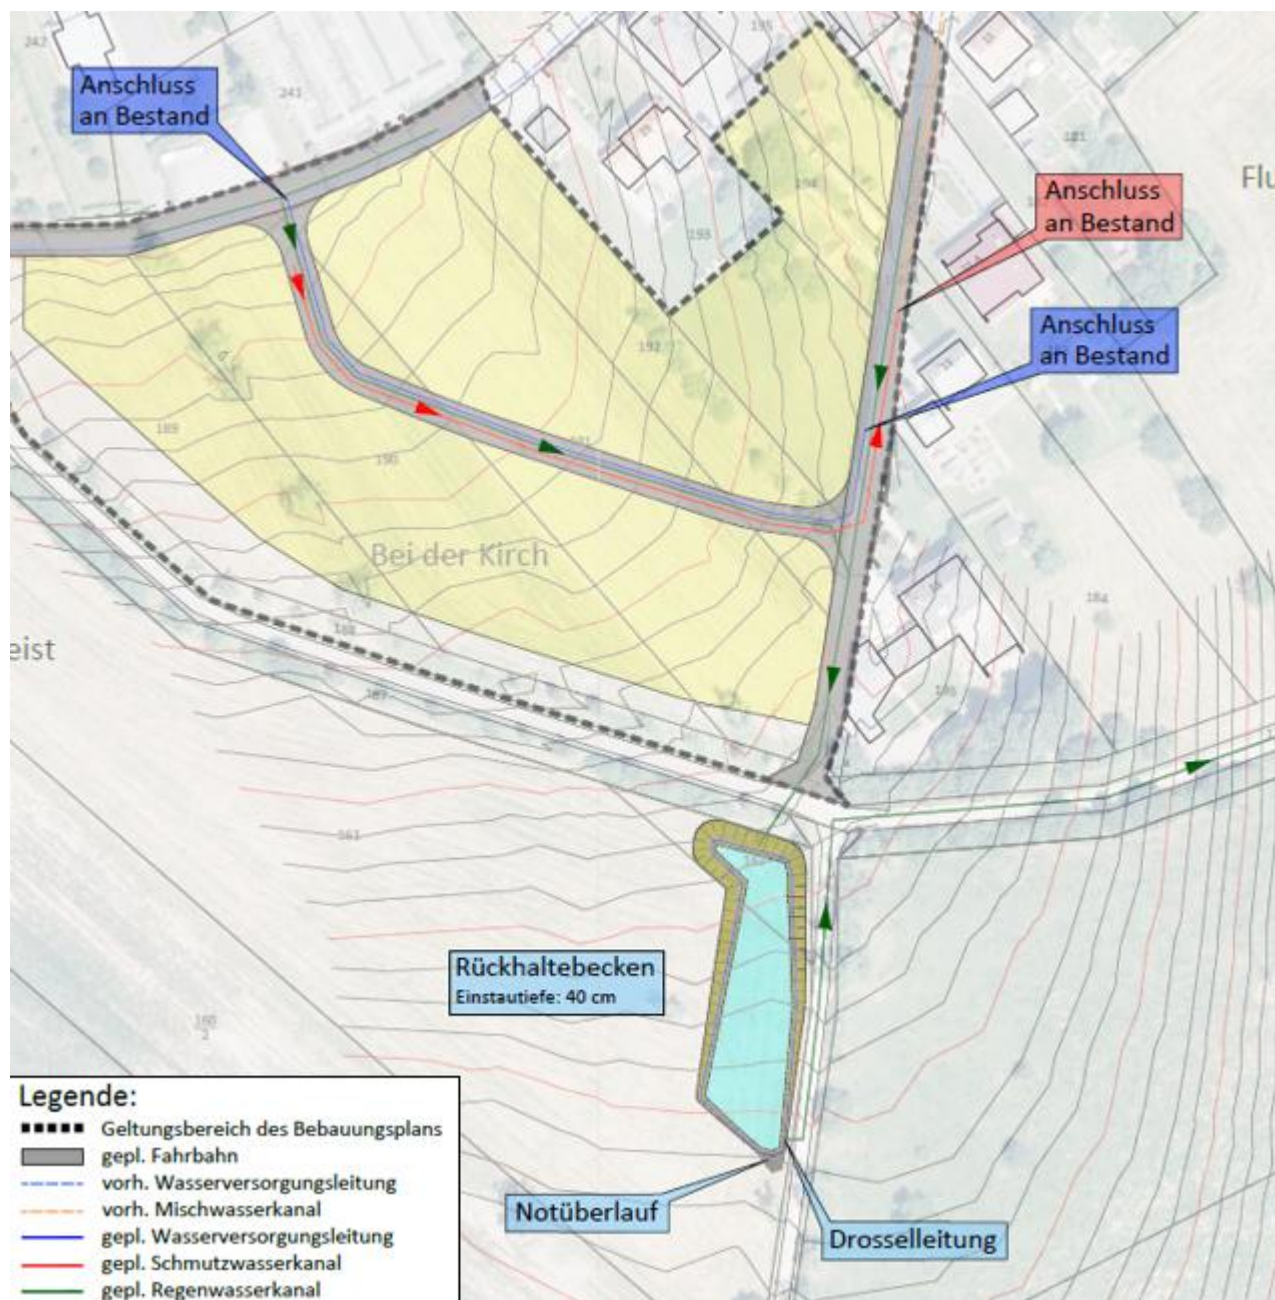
Plangebiet mit Darstellung der geplanten Entwässerung – Detailansicht Rückhaltebecken
